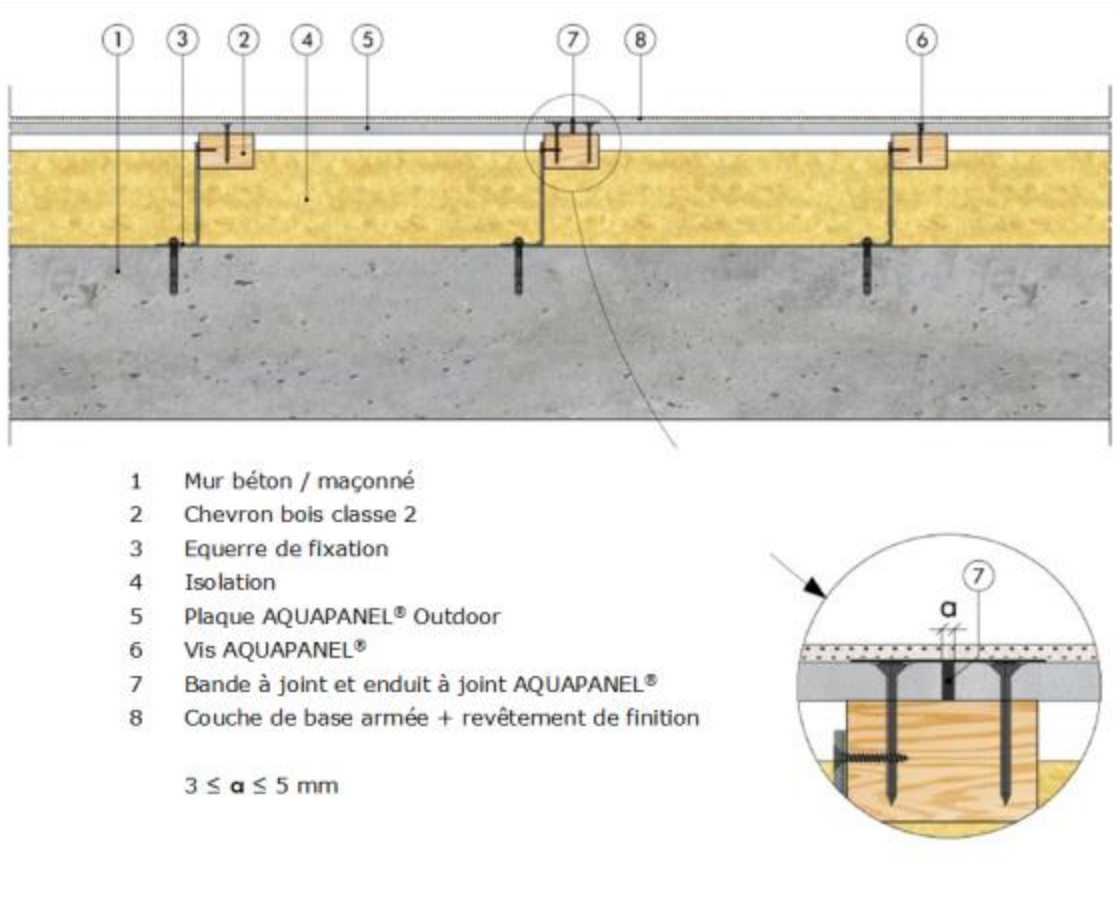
Traitement des joints entre plaques (coupe horizontale)
